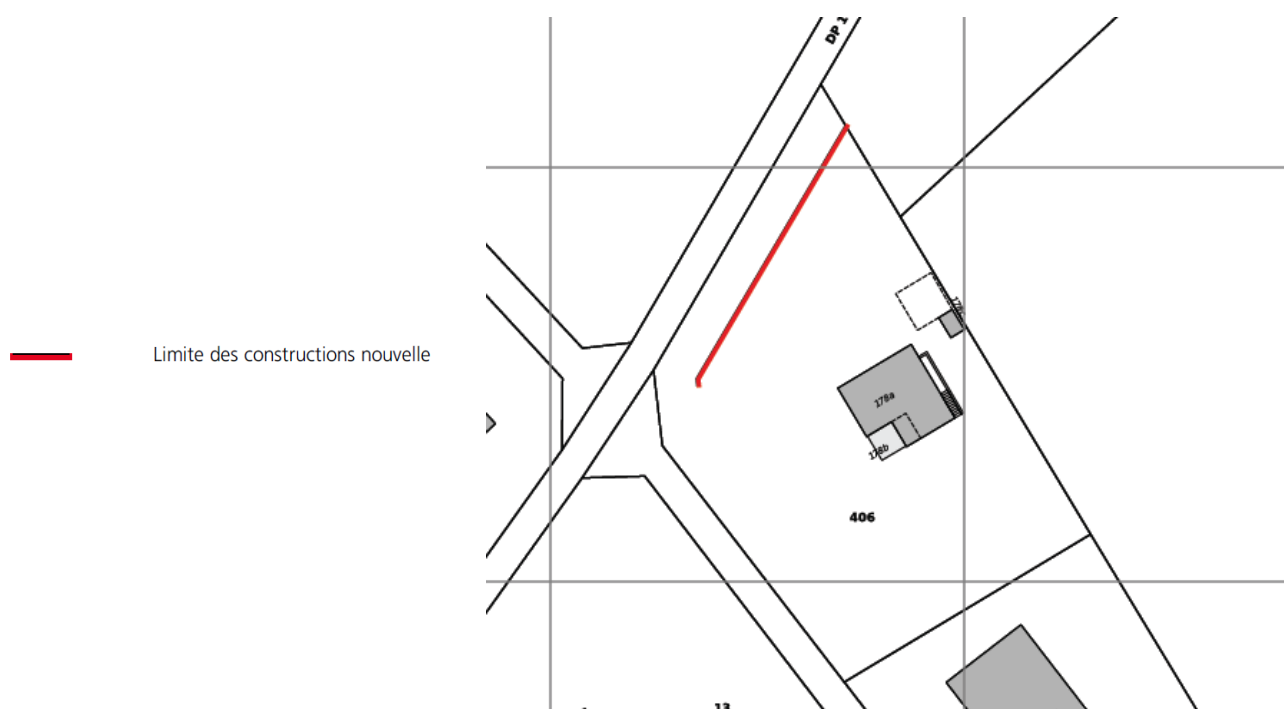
Extrait du Plan fixant la limite des constructions mis à jour
